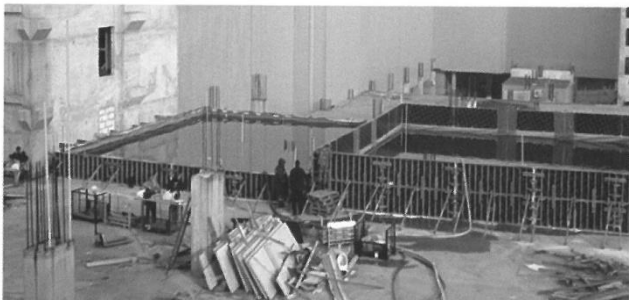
Випробування фрагменту перекриття другого поверху. Навантаження прикладається шляхом наповнення емкостей водою. Вигляд зверху
